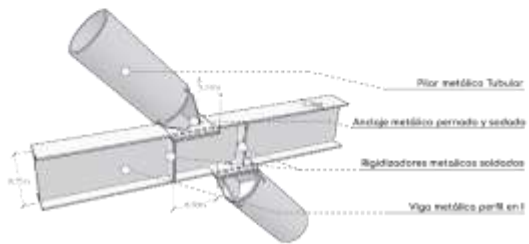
, Detalles de uniones pilares y vigas. Elaboración propia.
